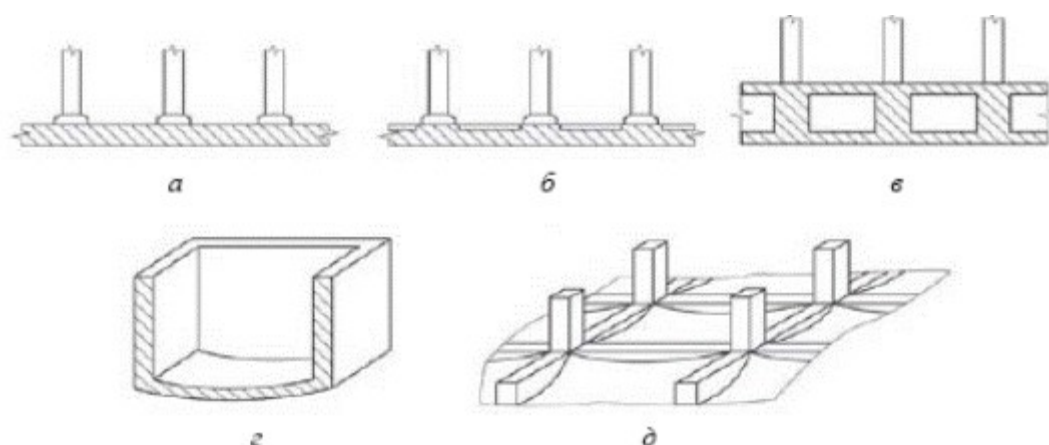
Сплошные фундаментные плиты: *а* — под стены или колонны; *б* — плитно-балочный вариант; *в* — коробчатые; *г* — в виде цилиндрических оболочек; *д* — оболочек двойной кривизны
